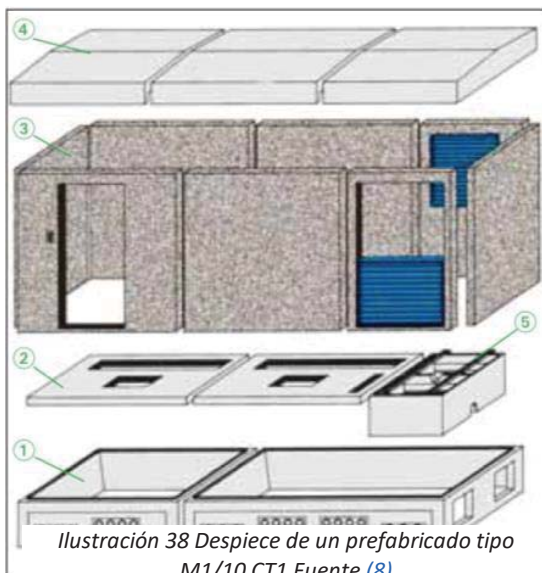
Despiece de un prefabricado tipo M1/10 CT1 Fuente [\[8\]](#)
